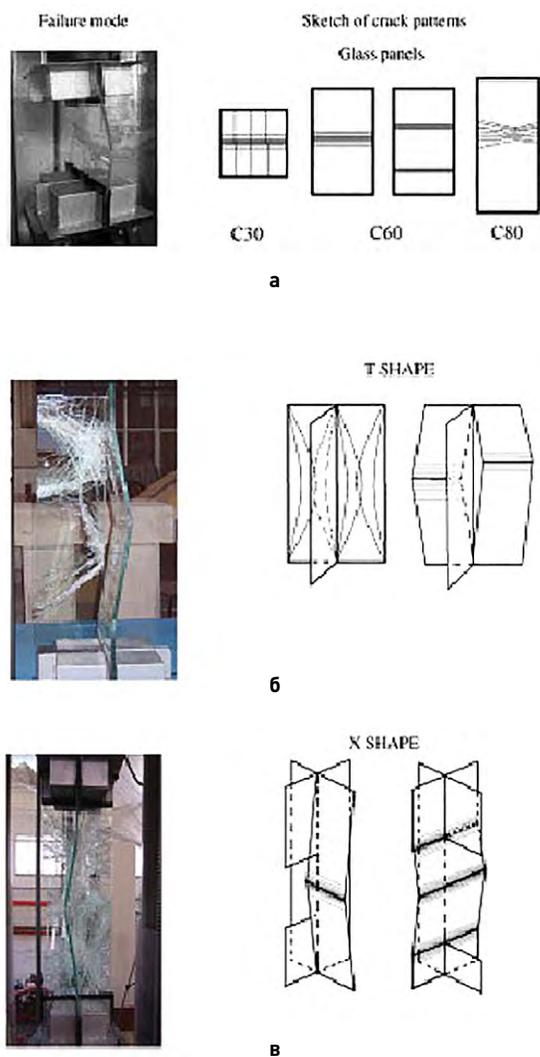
Испытания на сжатие колонн: а – лист; б – форма Т; в – форма Х [10]
